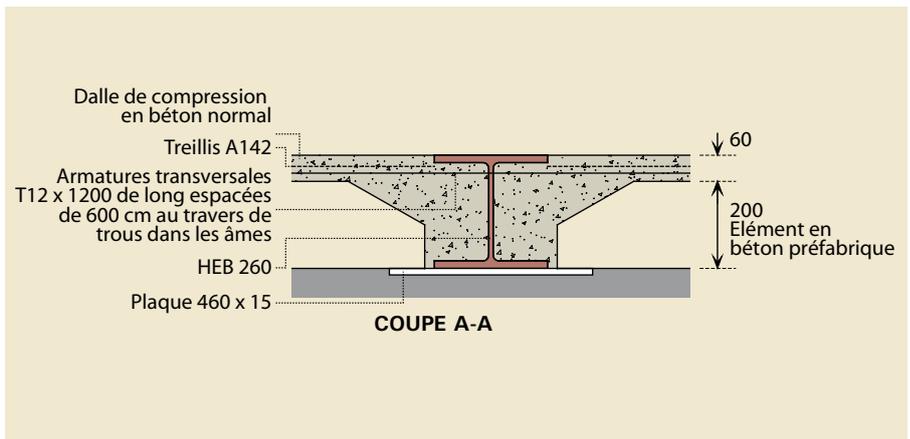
Disposition des poutres intégrées et des dalles préfabriquées en béton pour un bâtiment à trame rectangulaire de 4 étages
